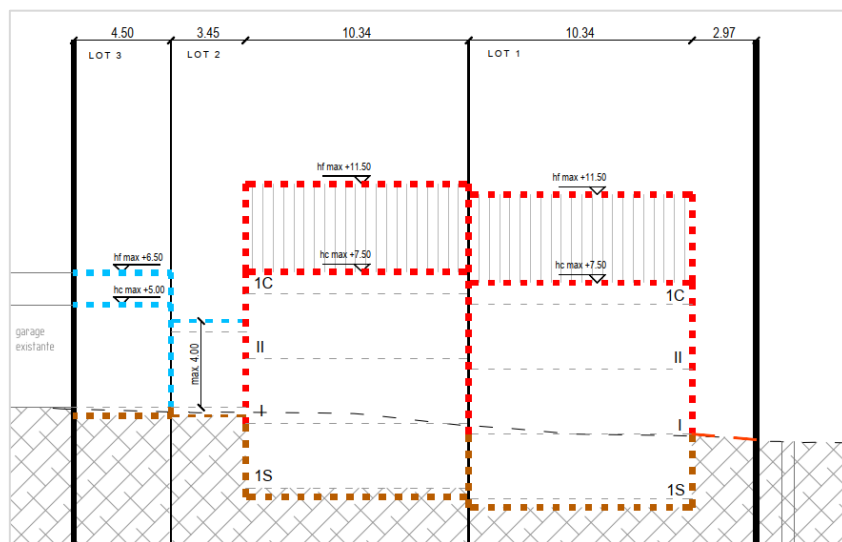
Coupe-Type des constructions projetées (Source: BEST)
